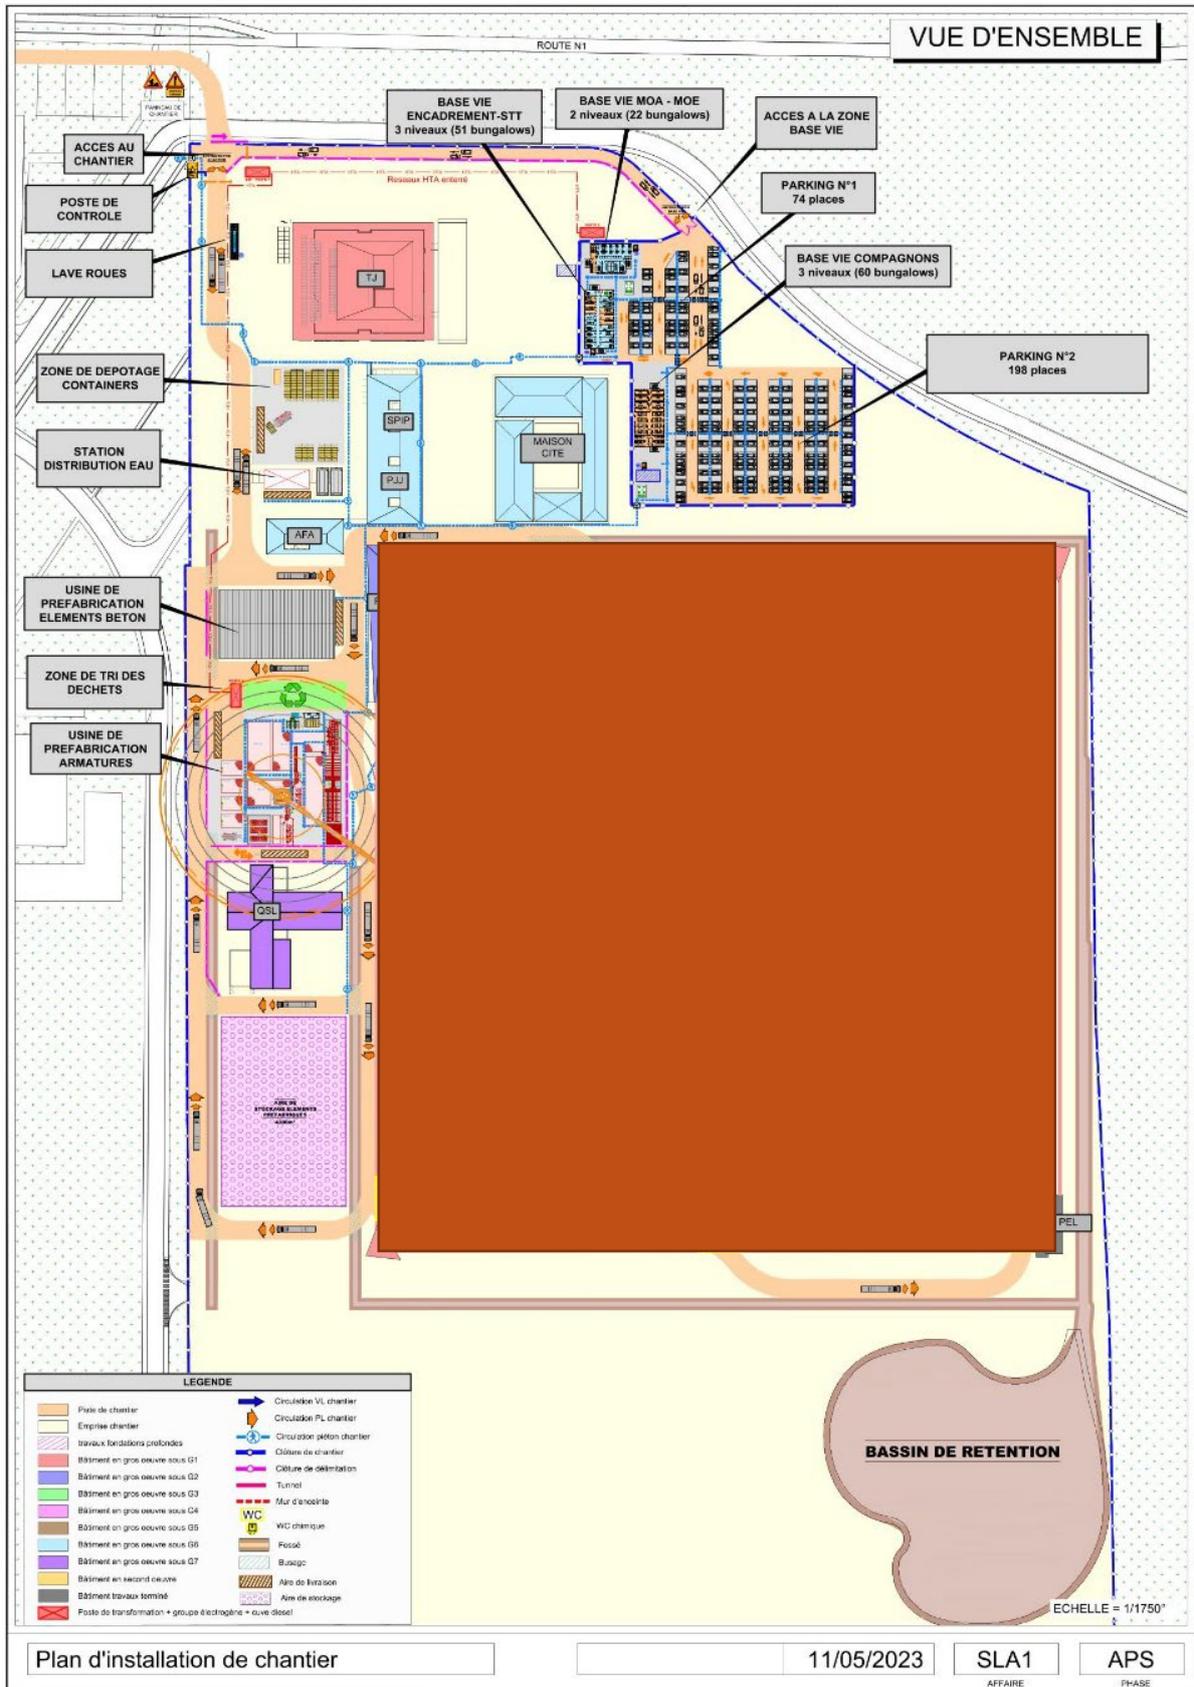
Plan d'installation du chantier (Source : Pizzarotti, 2024)
